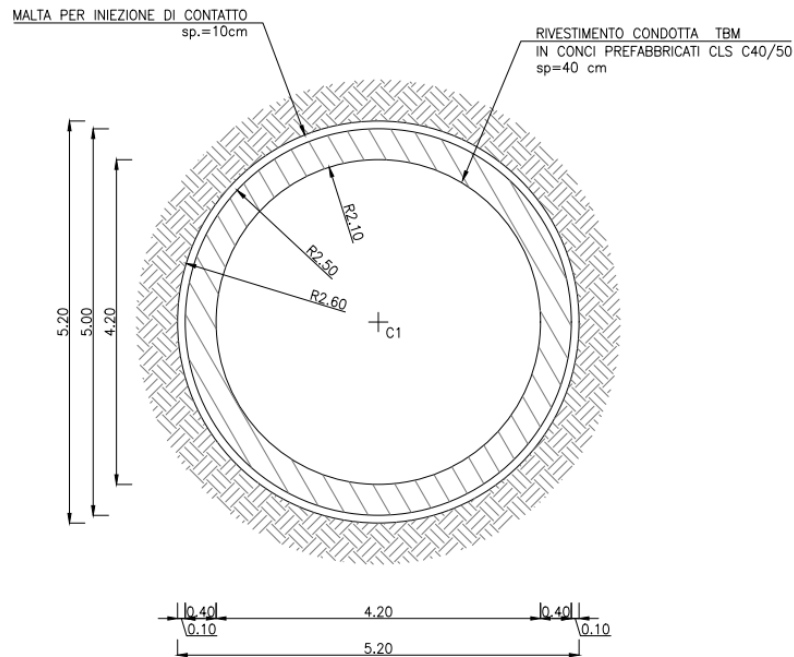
Sezione tipo della via d'acqua a valle della centrale
